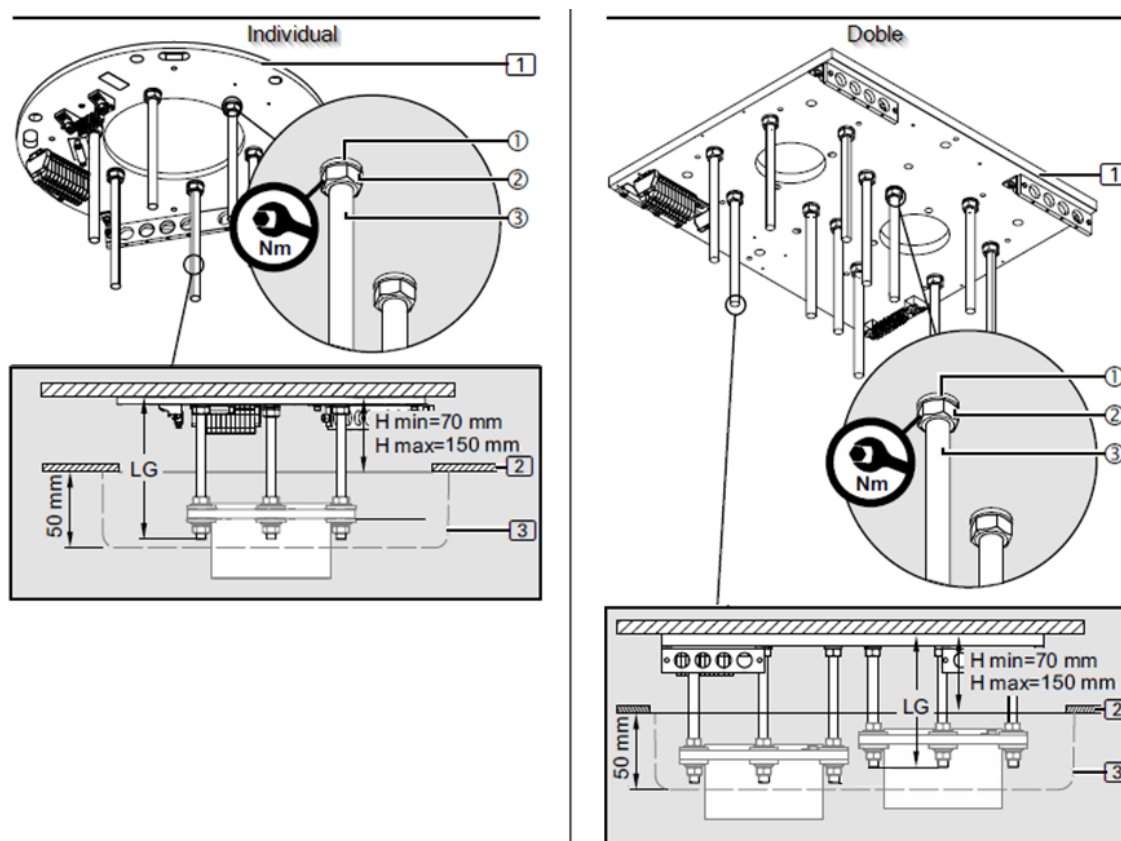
Installation de la plaque d'interface avec le faux plafond
